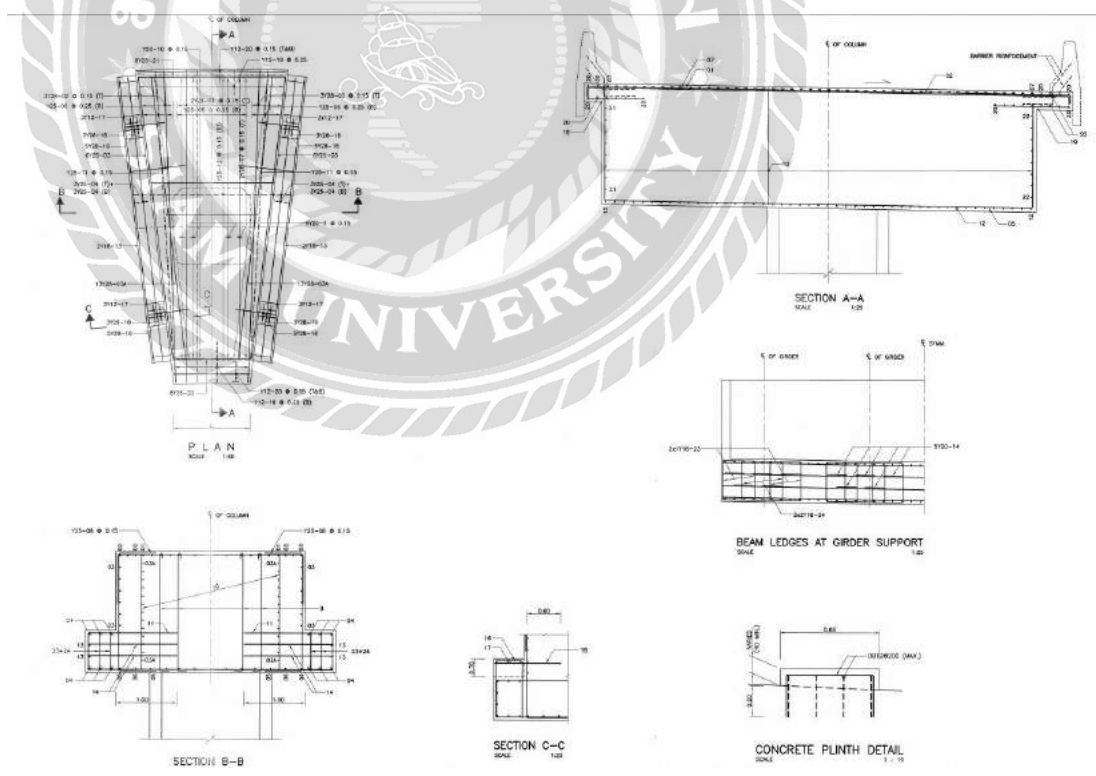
ภาพ Plan Girder Layout งานก่อสร้างถนนทางเชื่อมยกระดับพระราม 9
